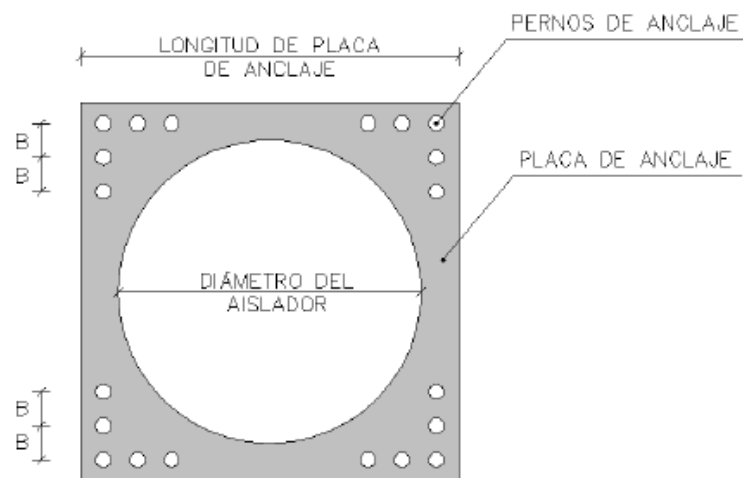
Vista en planta del aislador de bajo amortiguamiento.
